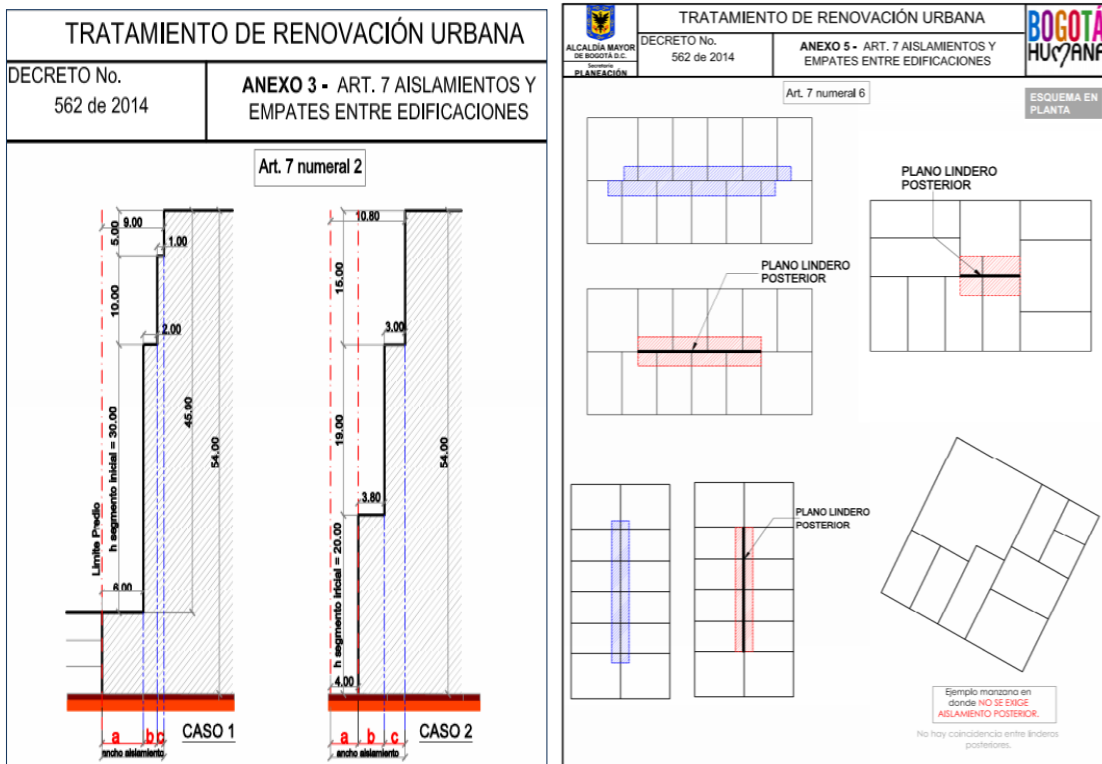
Detalle de Aislamientos Decreto 562 de 2014 – Fuente: SDP
